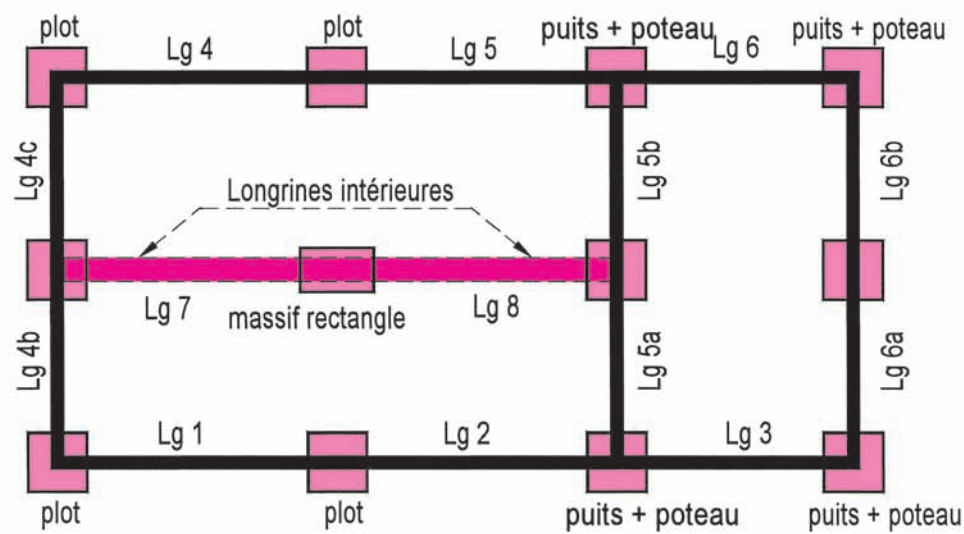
Vue en plan schématique des fondations sur plots et sur puits avec le repérage des longrines
